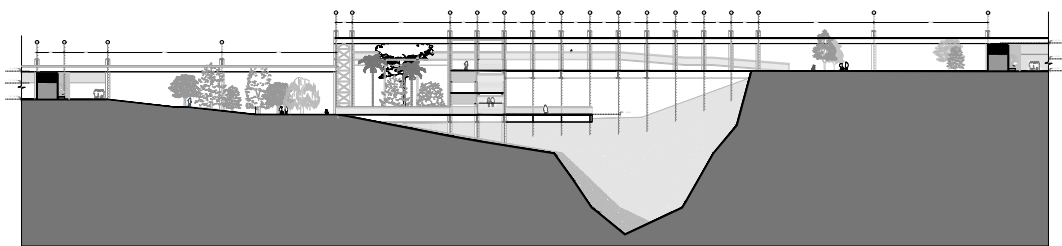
El puente con su estructura. Corte Arquitectónico.
